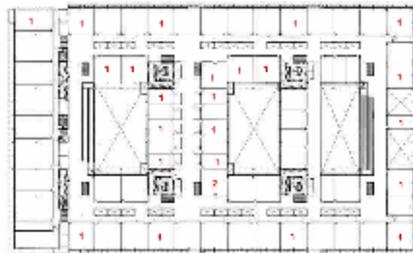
Planta baixa biblioteca térreo. (CORBIOLI, 2008.)
